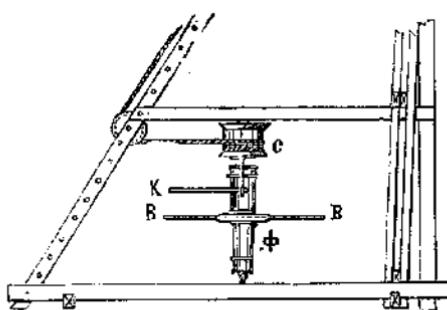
Машинный воротъ со шпиллями: ϕ —деревянный валъ; a, b —рукоятки; c —барабанъ; k —рычагъ.
